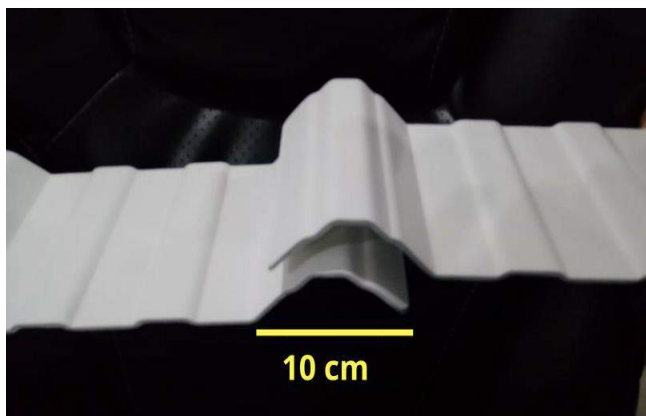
Traslape longitudinal (a lo ancho) de la lámina.* En la imagen se aprecia la medida que debe tomarse en cuenta para el traslape longitudinal (a lo ancho) de la lámina.
